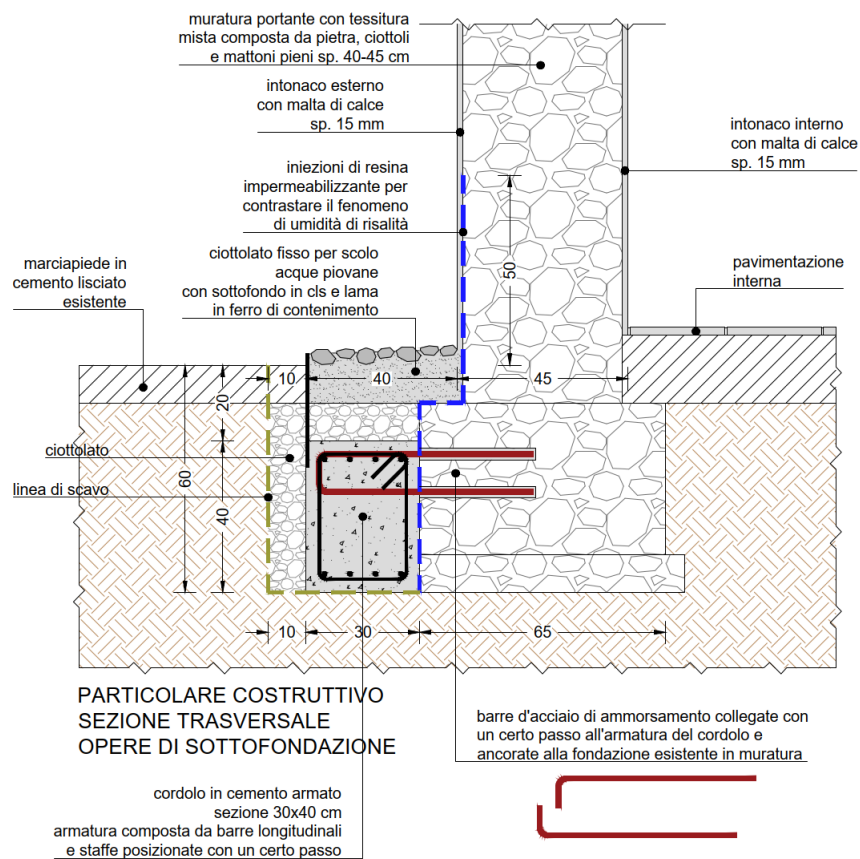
Particolare costruttivo opere di sottofondazione con ammorsamento – Sezione trasversale
